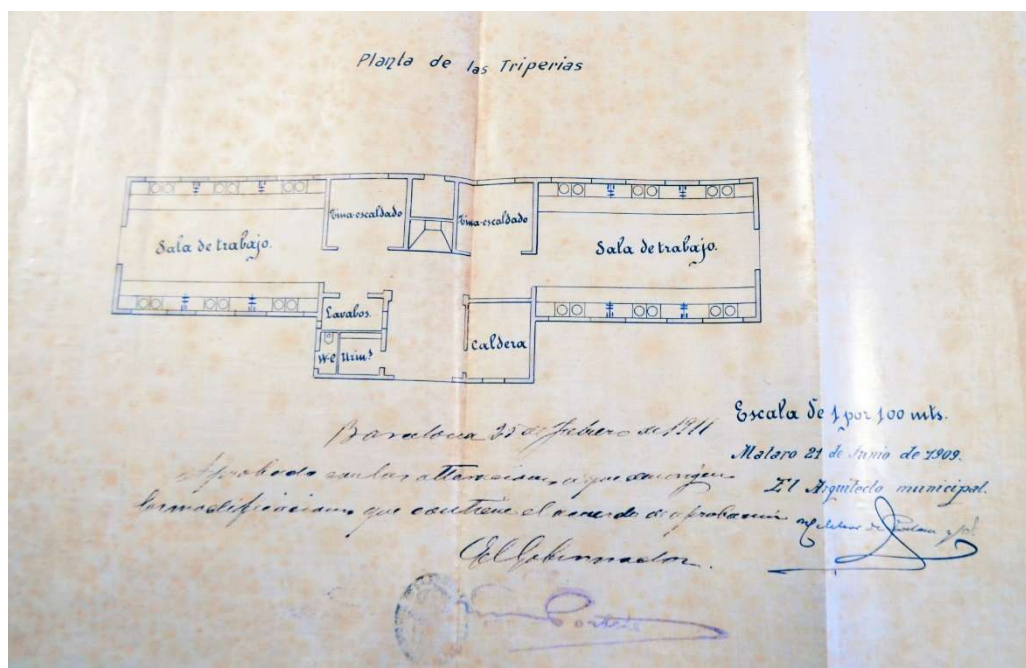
Plano de la proyección horizontal de las triperías. [12]
